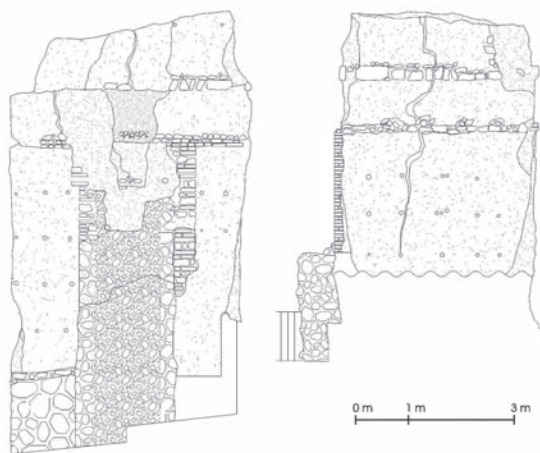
Alzados de las caras Este y Norte de la Torre de las Harinas (Zufre).
